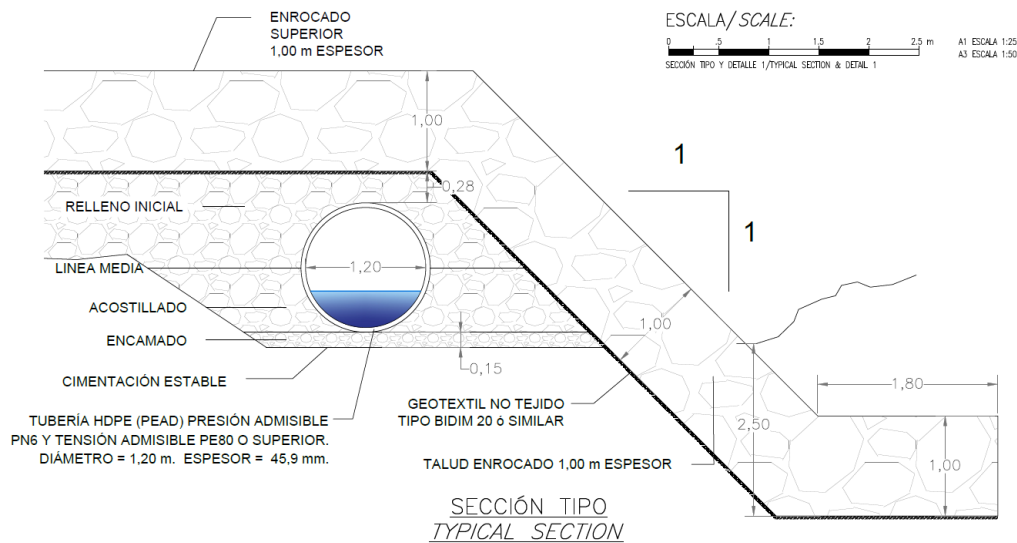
Sección transversal tramo de tubería HDPE de 1,2 m de diámetro y enrocado de protección
